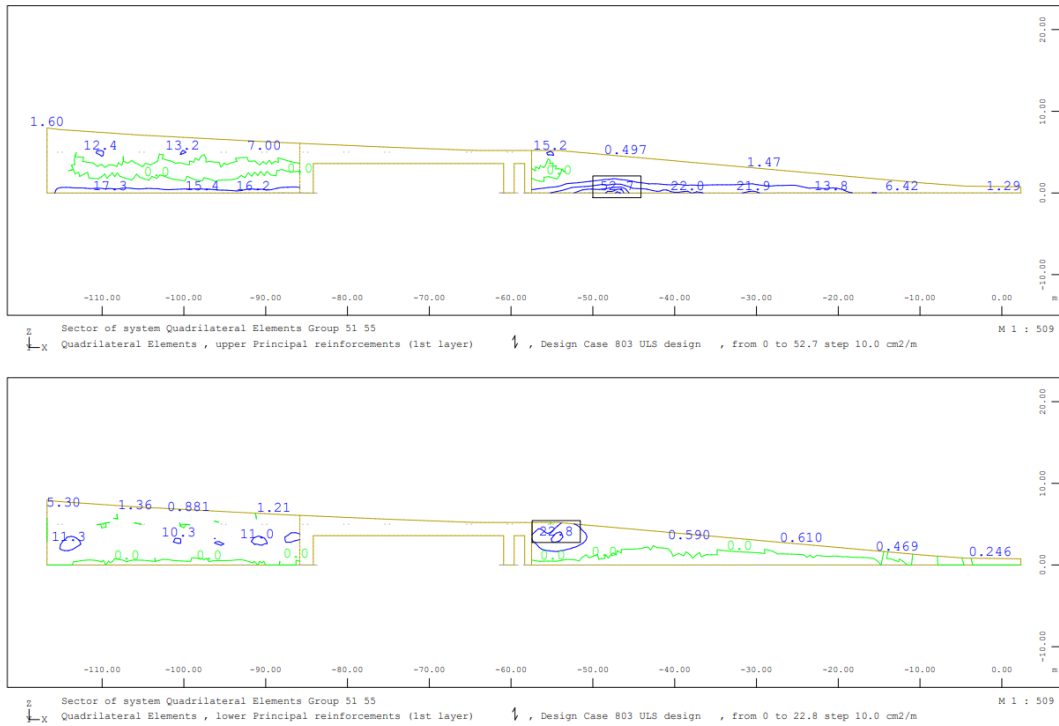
Armadura vertical na face exterior (sup.) e interior (inf.) – fachada Sul da Estação - ELU
